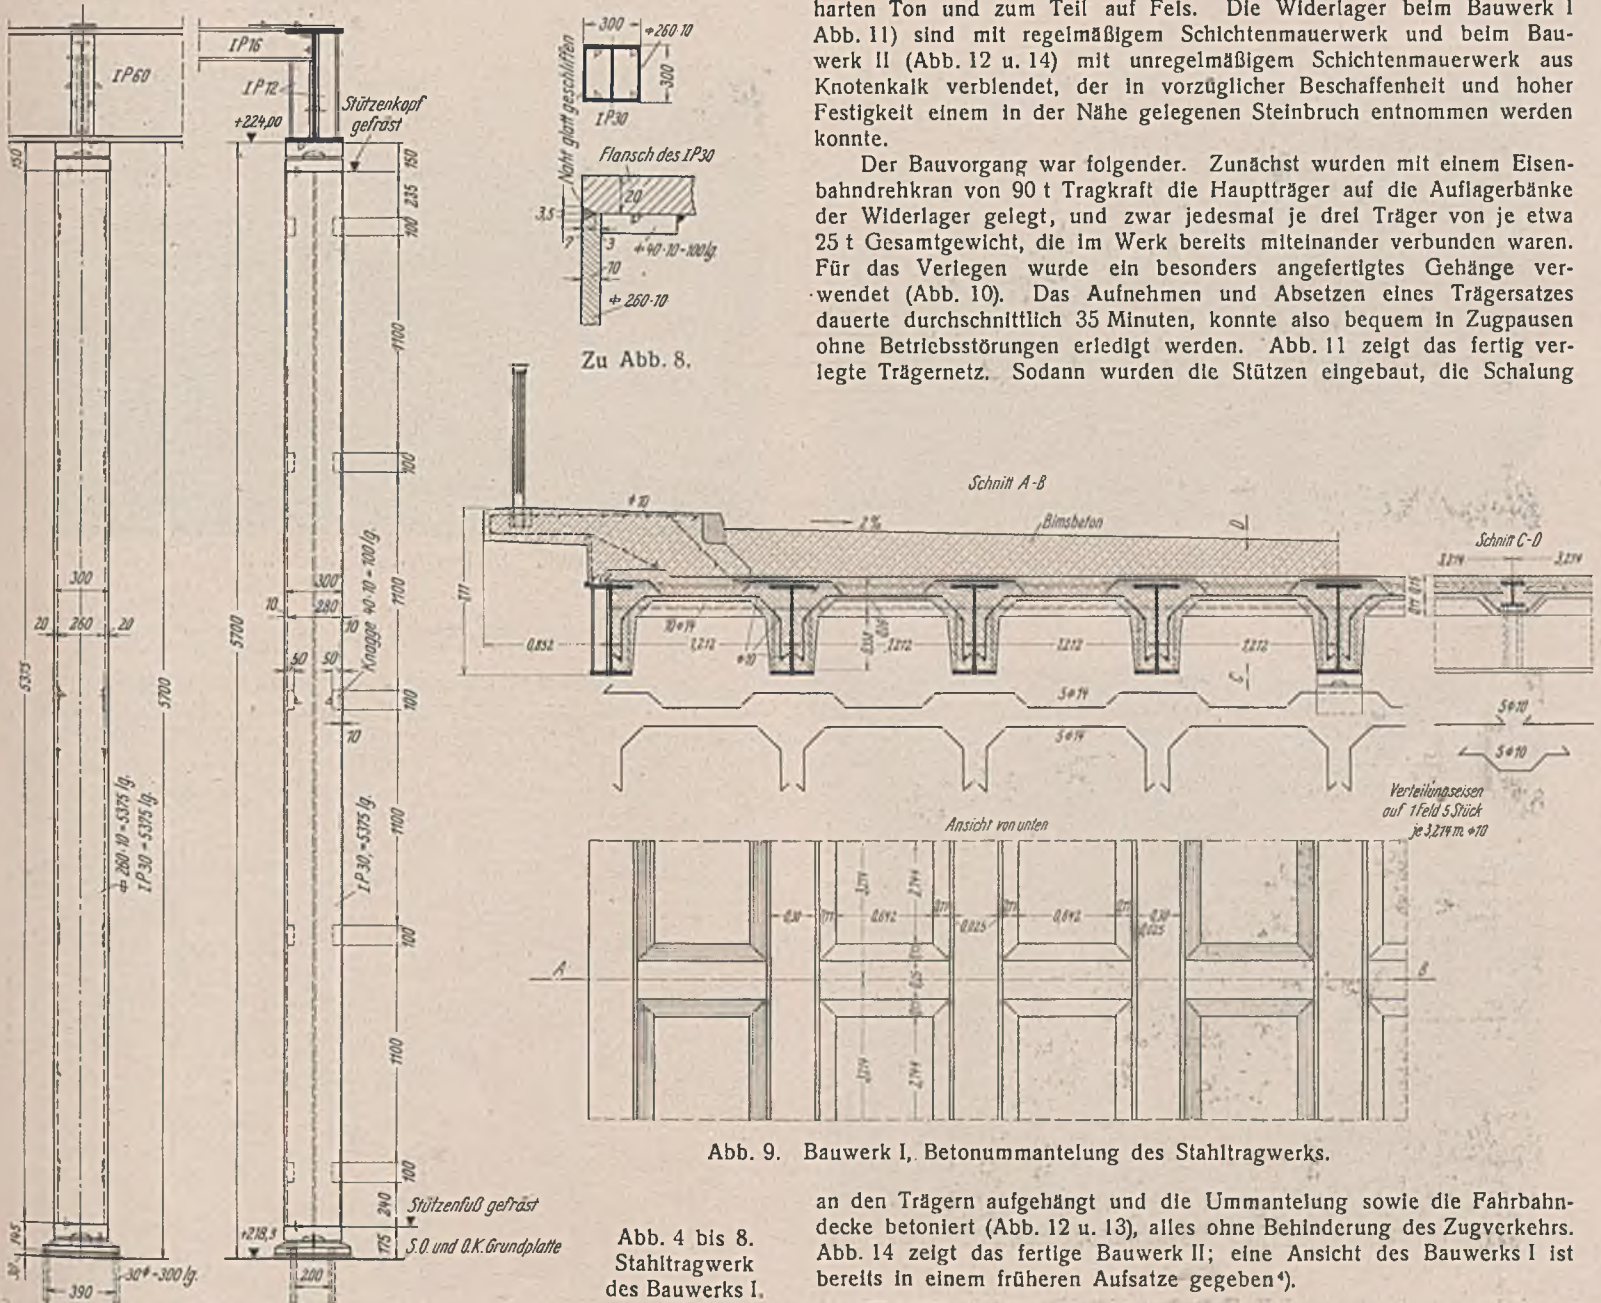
Bauwerk I, Betonummantelung des Stahltragwerks.
